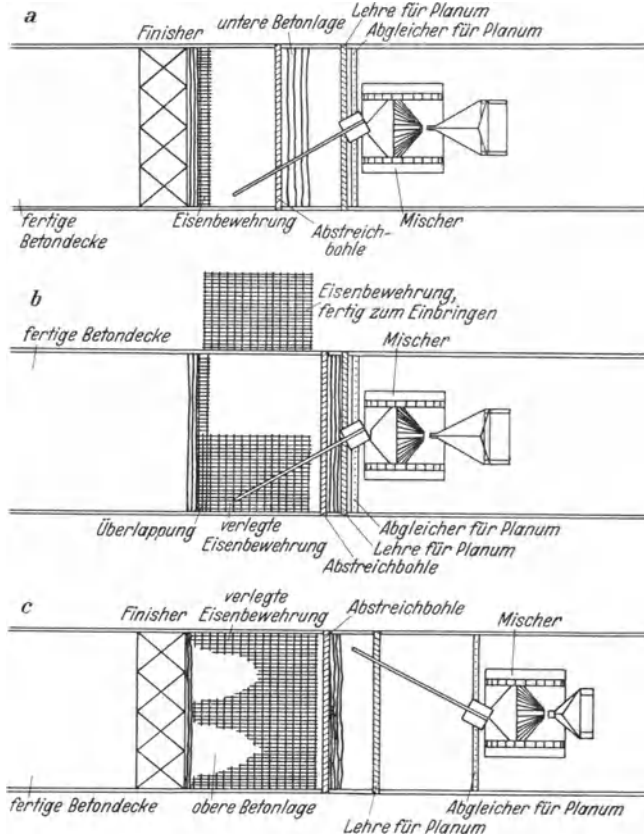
Schema des Arbeitsvorganges für eine bewehrte Betondecke in zweischichtiger Bauweise. a) Herstellung der unteren Betonlage, b) Verlegung des Eisens auf der unteren Betonlage, c) Aufbringung der oberen Betonlage [C 106].
